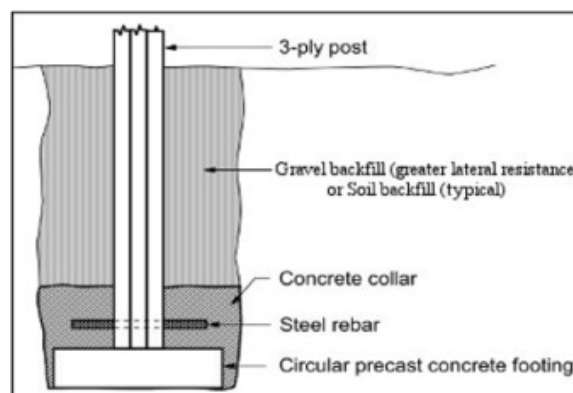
Esempio di fondazione ottenuta mediante perforazione del terreno e successiva creazione del palo di fondazione con getto di cemento.
